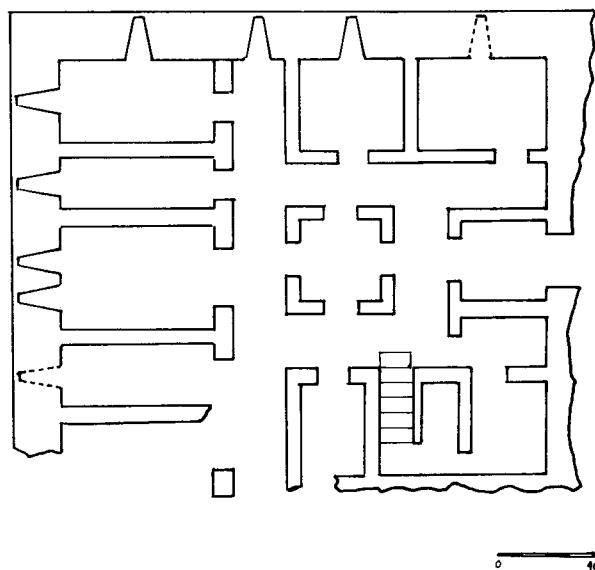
Planta do Castelo da Lousa segundo A. do Paço e Bação Leal.
